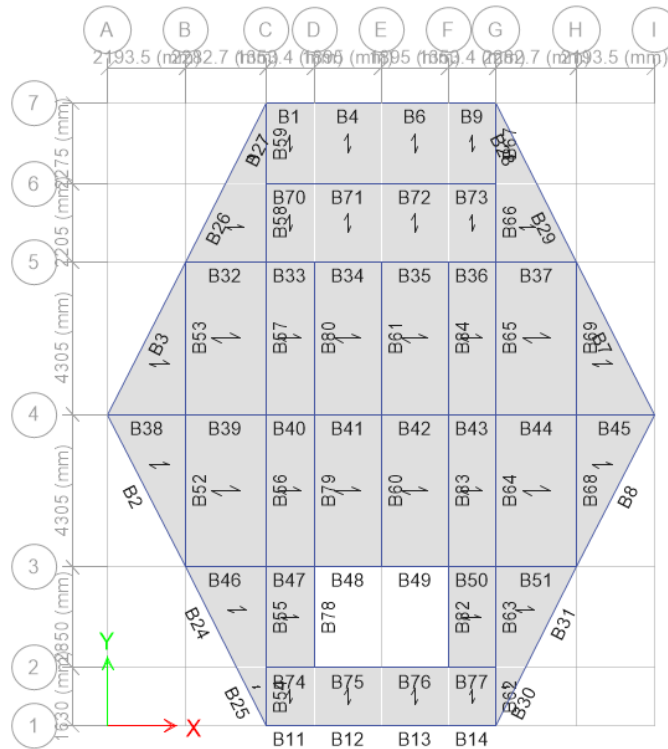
Visualización de etiqueta de vigas en una vista en planta de la estructura
